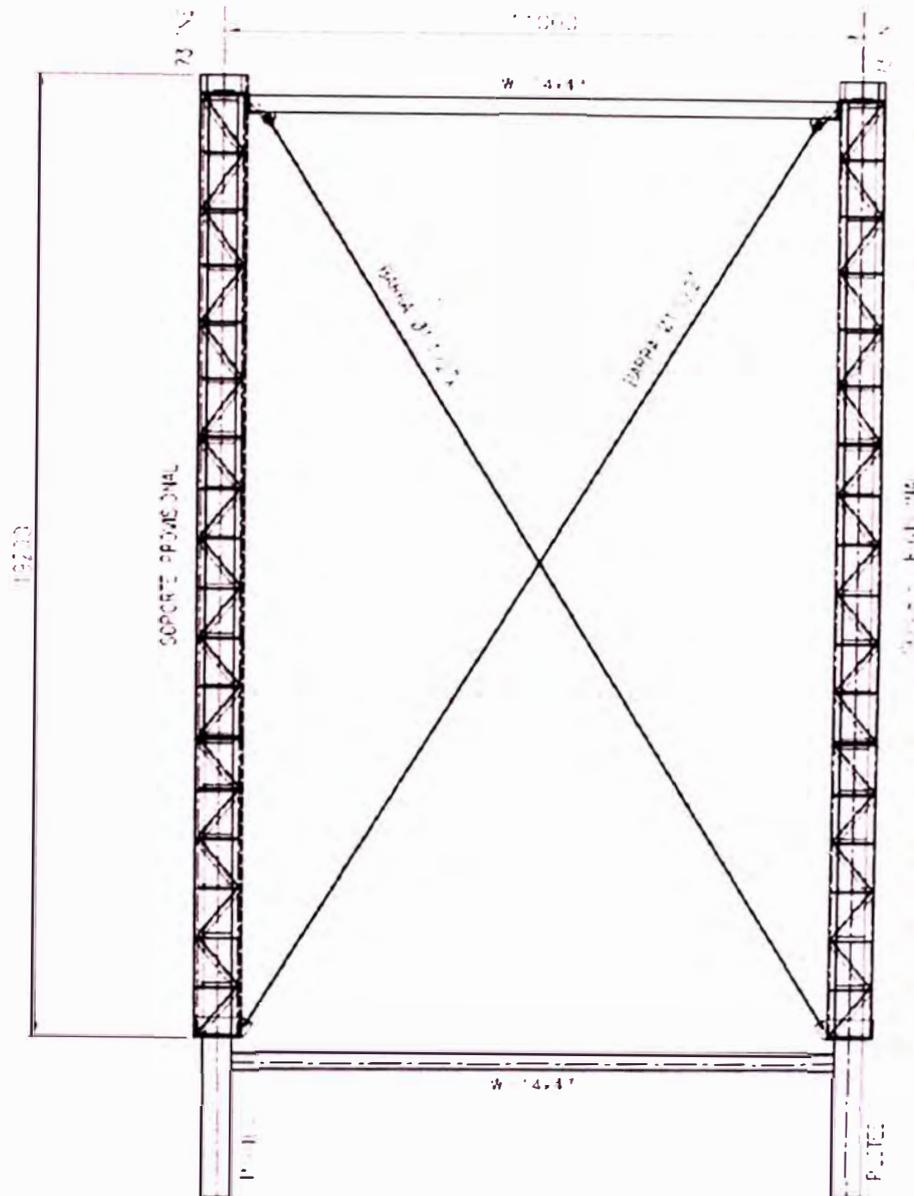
ESQUEMA DE ARRIOSTRES ENTRE COLUMNAS
